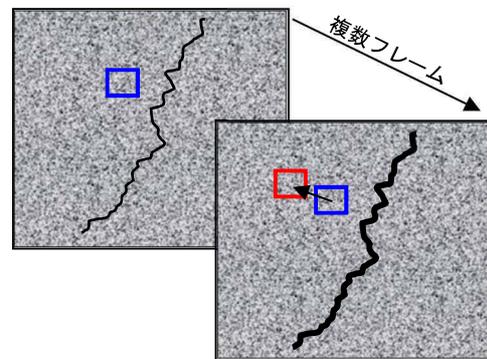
画像相関法によるひび割れ周辺の変位場評価
